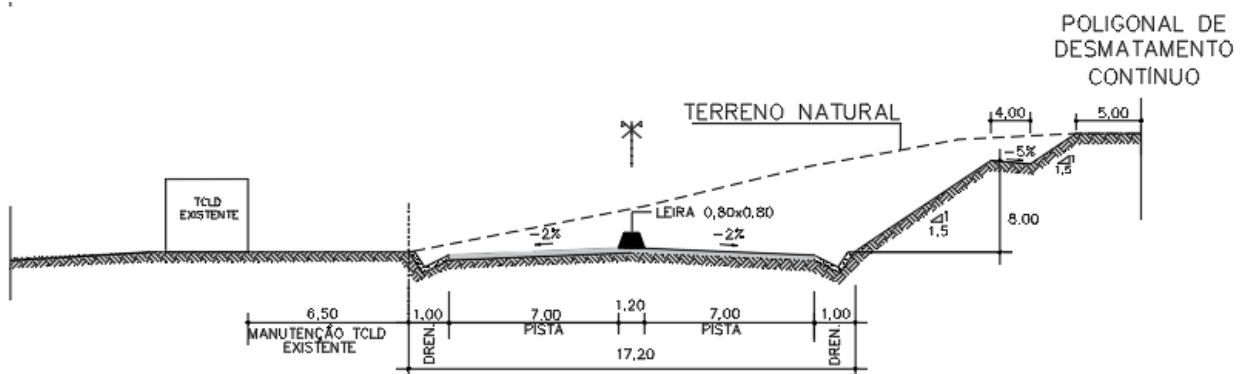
Vista da Seção Existente da estrada – SEÇÃO DE CORTE
